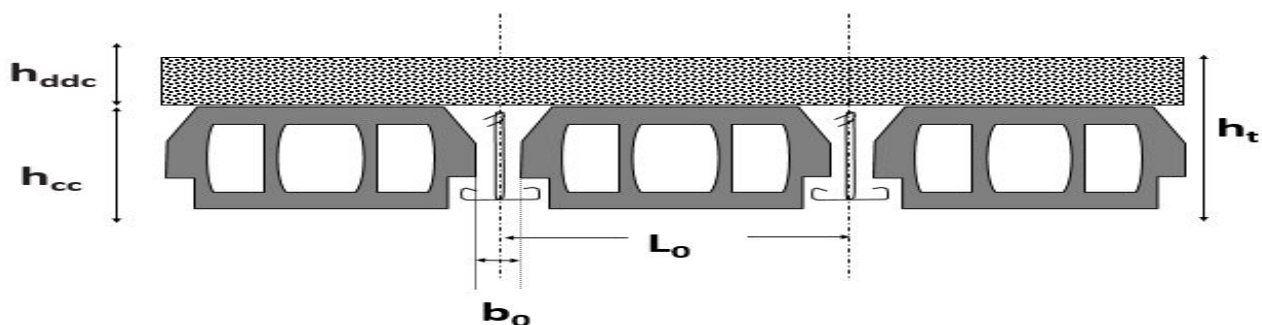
Coupe transversale sur un plancher à corps creux
